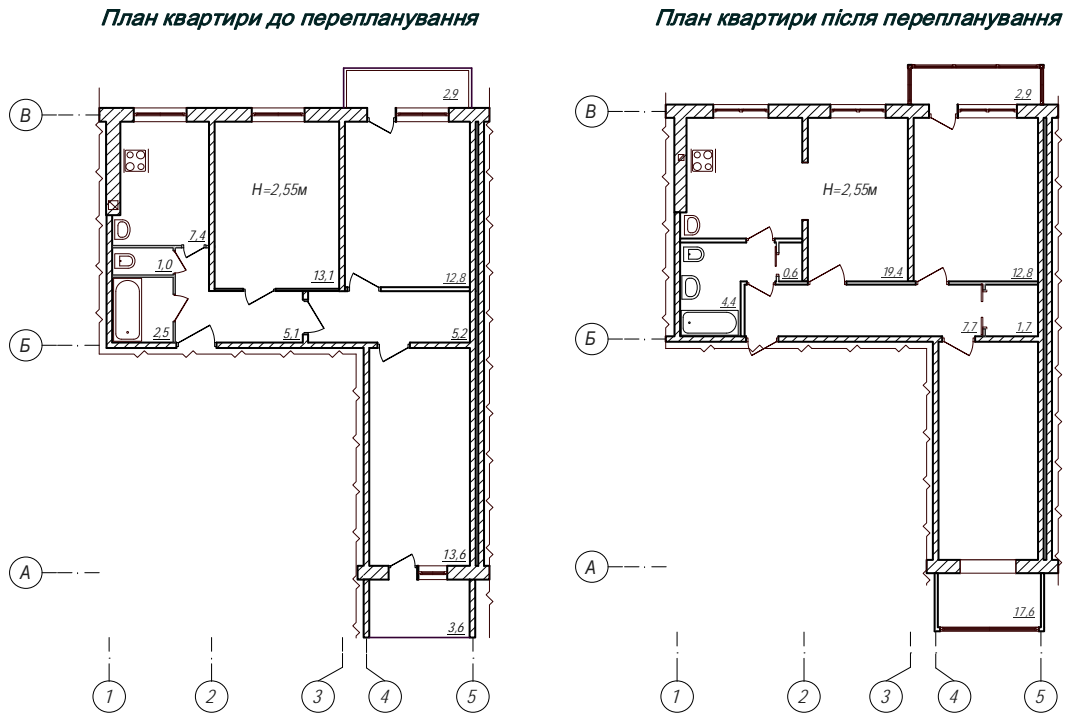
Найбільш поширений варіант перепланування трикімнатної квартири в житловому будинку серії 1-464Д
